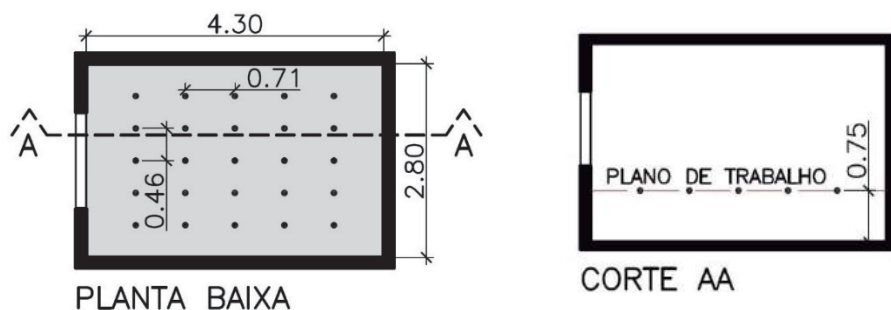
Planta baixa e corte AA indicando a malha de pontos para medição de iluminância.
